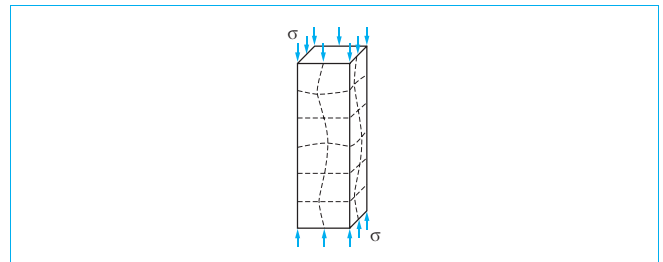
Voilement local dans un poteau à section tubulaire à parois minces
